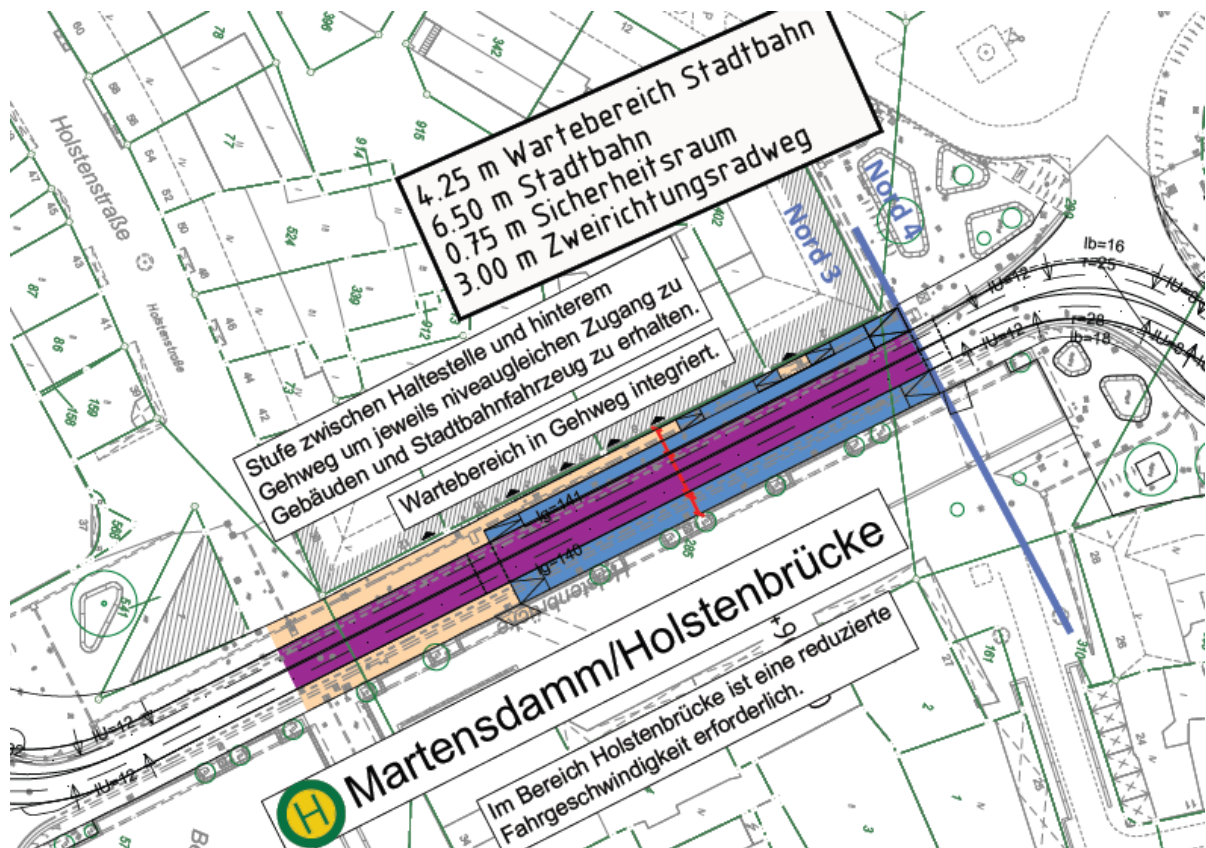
Lageplan an der Holstenbrücke mit Haltestelle (Rückfallebene)
